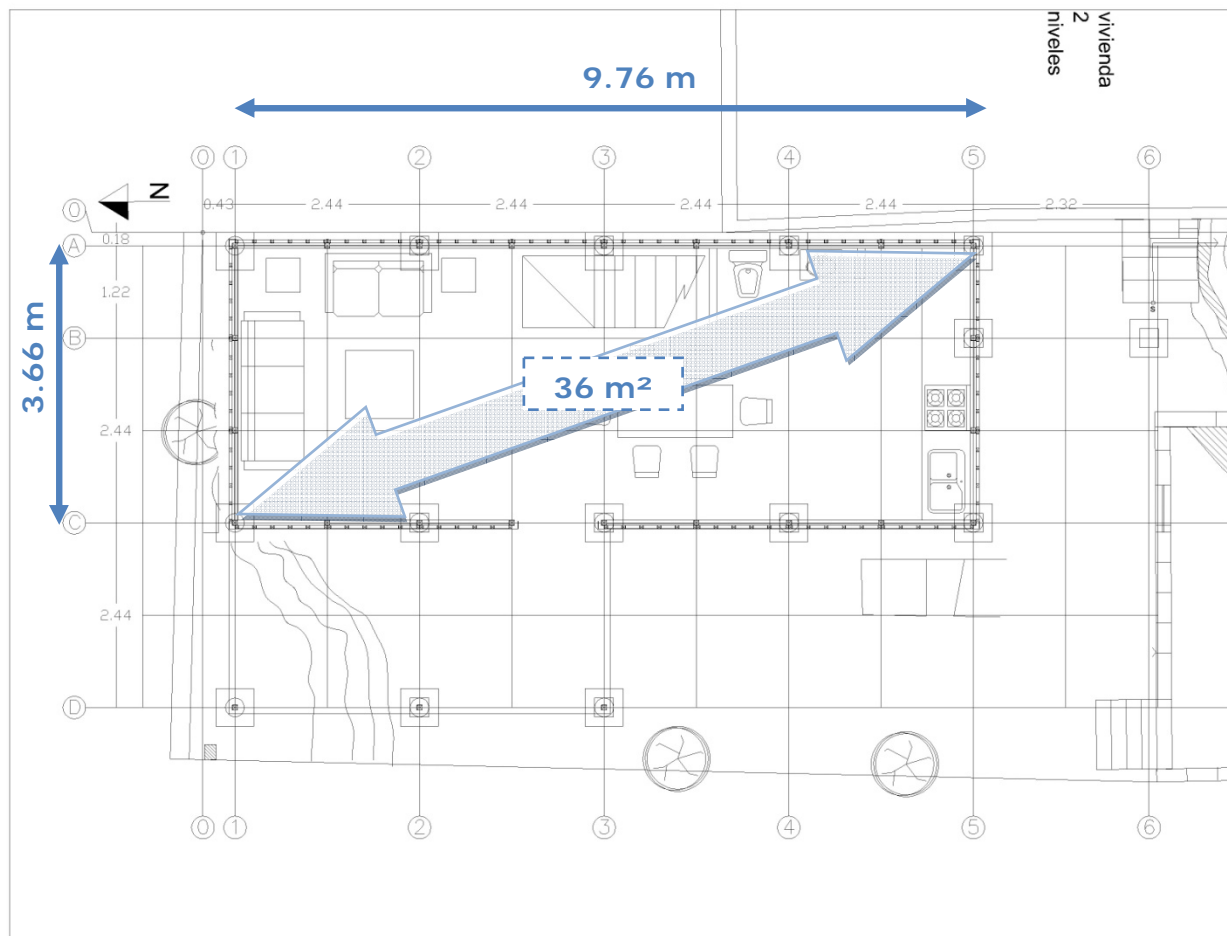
c-1 - Plano de la planta baja de la casa Rosenda [15]
